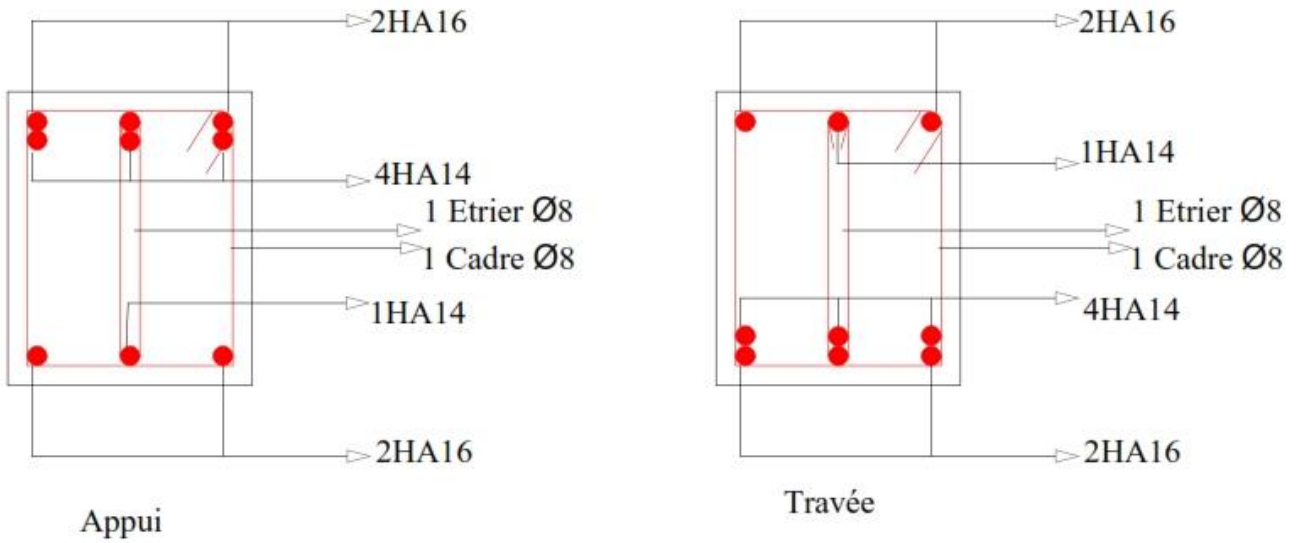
Schéma de ferrailage des poutres (terrasse inaccessible).
